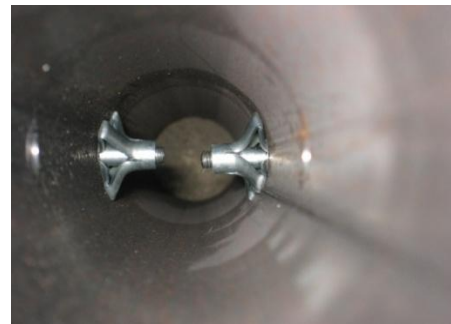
鋼管内部の状況 (ワンサイドボルト)
